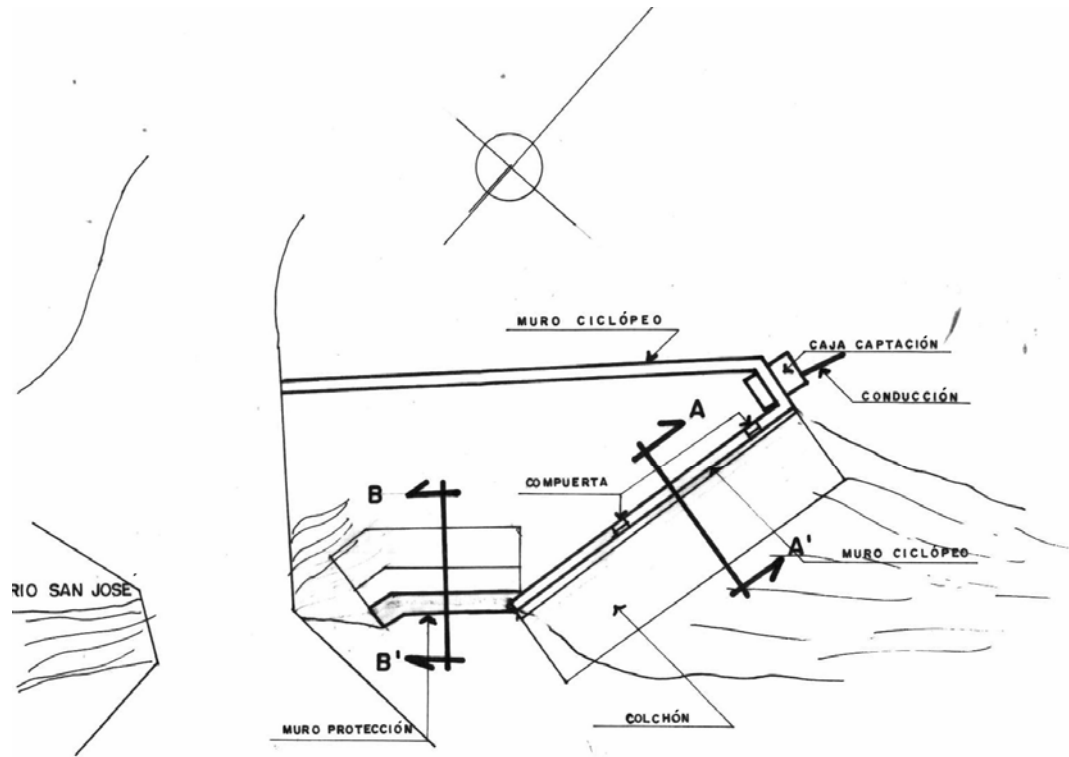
Protección muro lateral (fuente: Grupo CALSA)
